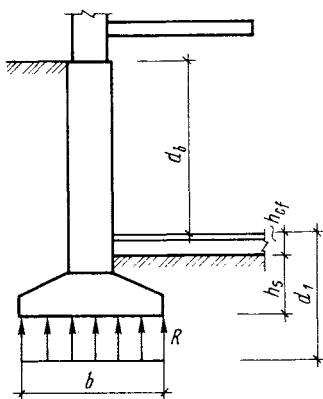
Схема к определению расчетного сопротивления грунта основания
